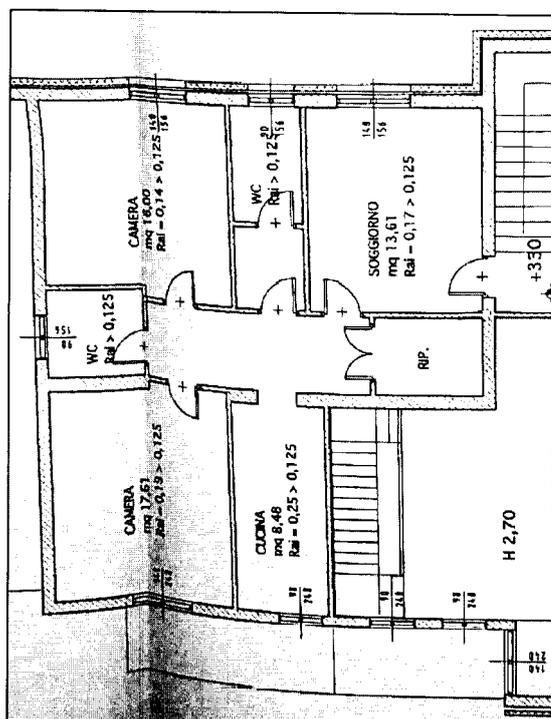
Estratto planimetria C.E. 8.11.1995 P.1°
